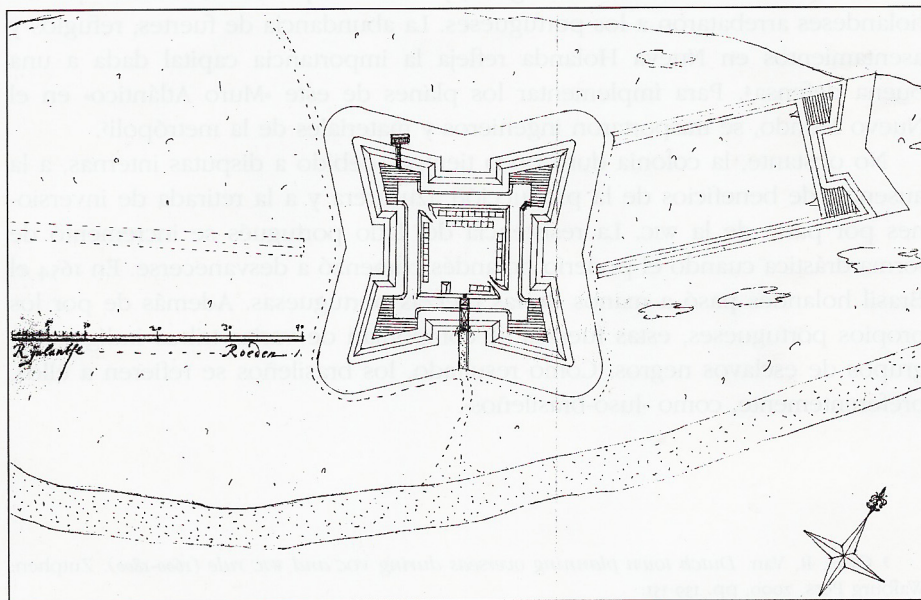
Plano de planta del Forte Orange. Mencionado en el dorso: «Fort Orangen 1637», Koninklijk Huis Archief, La Haya.
